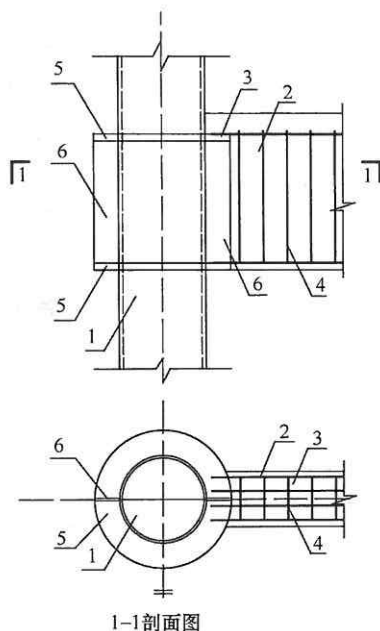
钢筋混凝土梁-钢管混凝土柱外加强环节点
